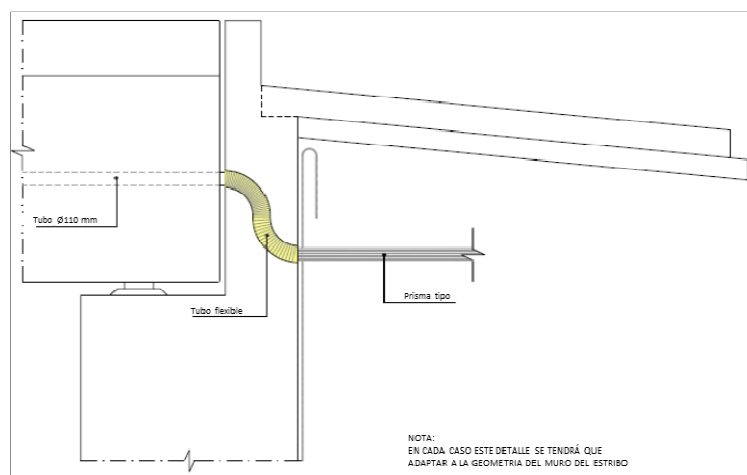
Detalle de salida de canalización enterrada con tubo metálico.
